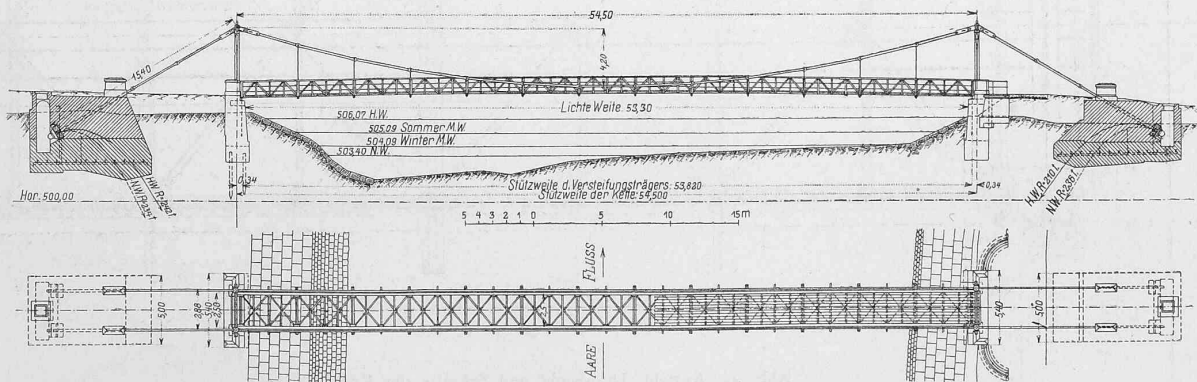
Uebersichtsplan des Kettensteges. Ansicht und Grundriss. — Masstab 1:500.
